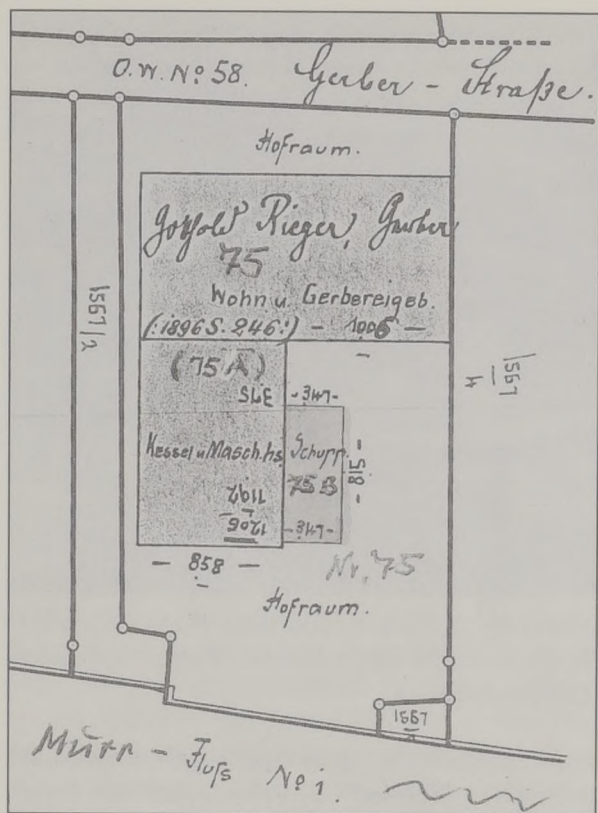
Lageplan von 1914 mit einem Schuppen-Anbau am Kesselhaus der Lederfabrik Gottfried Rieger, Gerberstraße 75.
